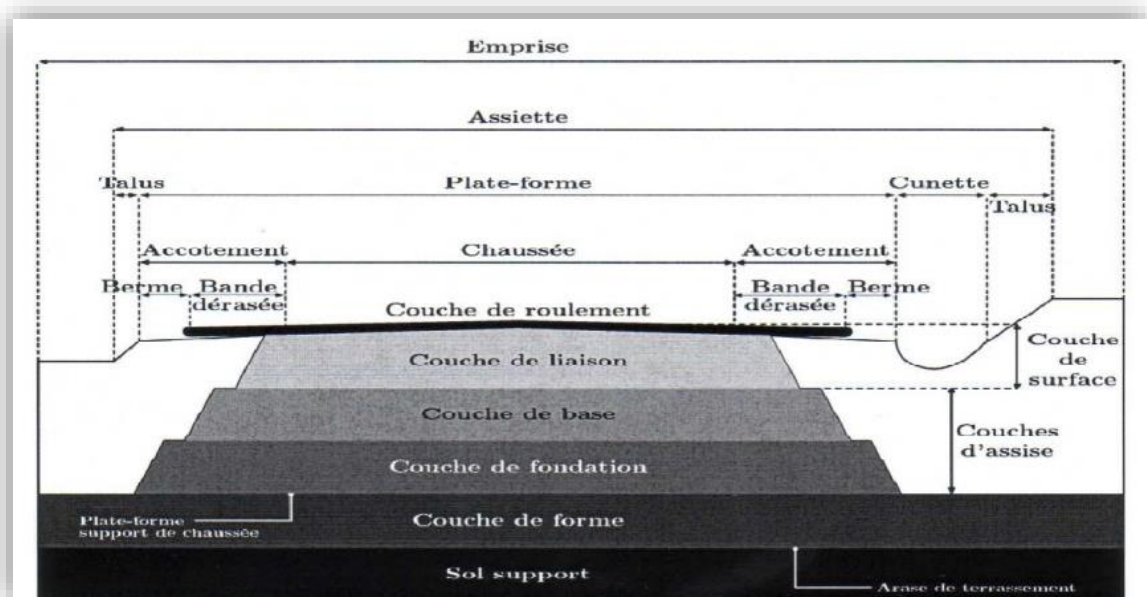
Coupe transversale démontrant les différentes couches d'une chaussée souple.
